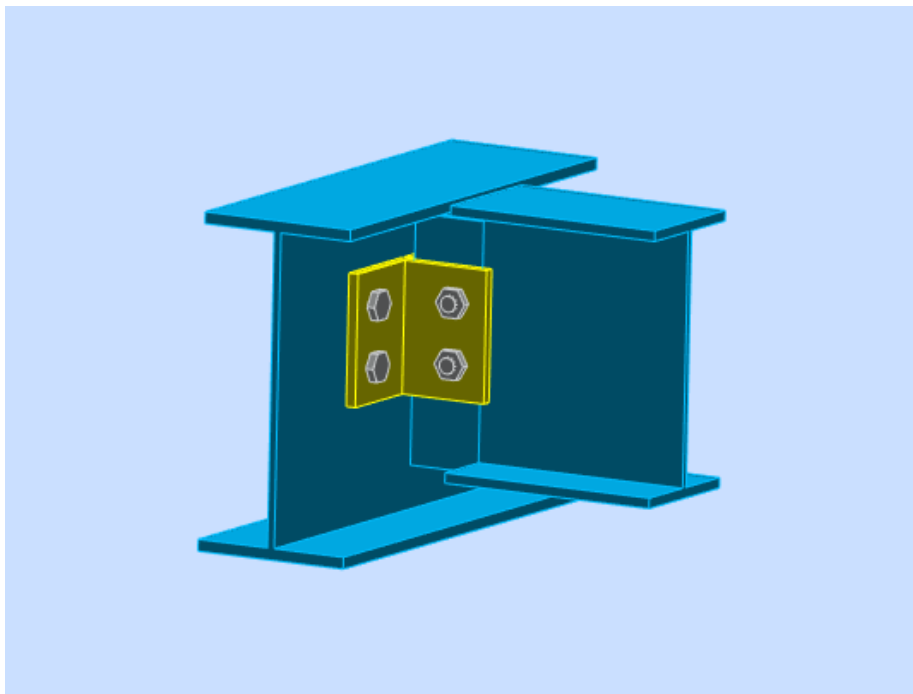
vue assemblage poutre-solive en 3D.
